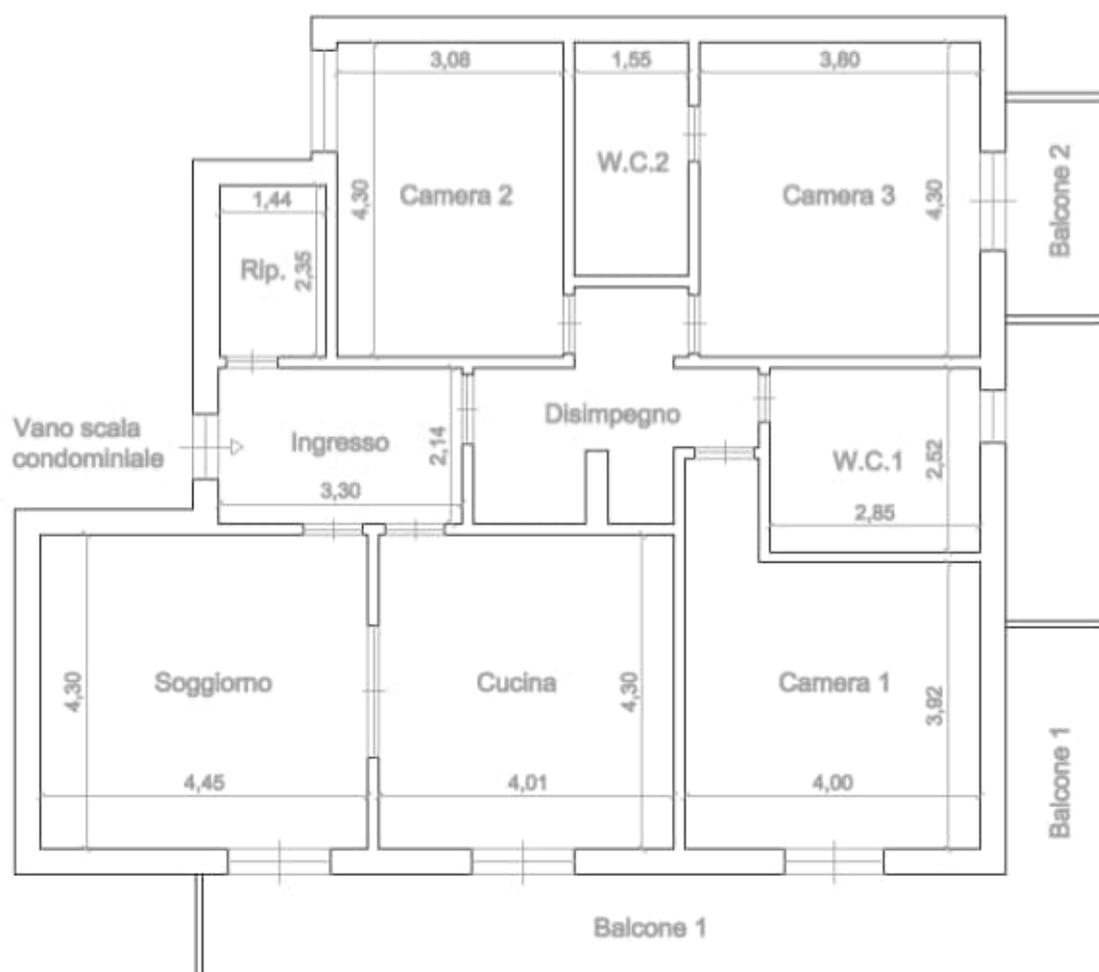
Planimetria - Stato di fatto rilevato dal C.T.U.
